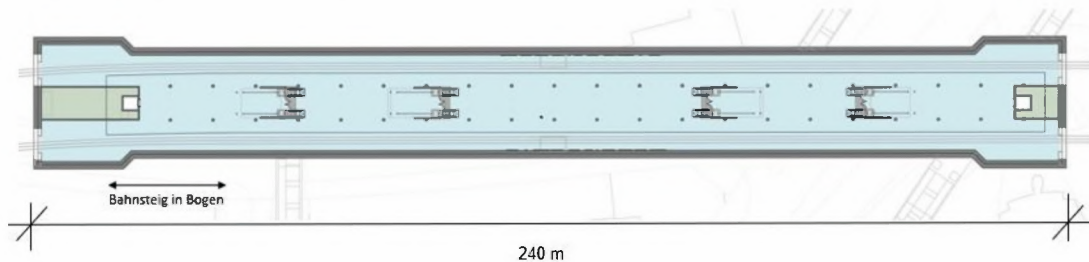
Hp Alsenplatz Var. II – Grundrisse
